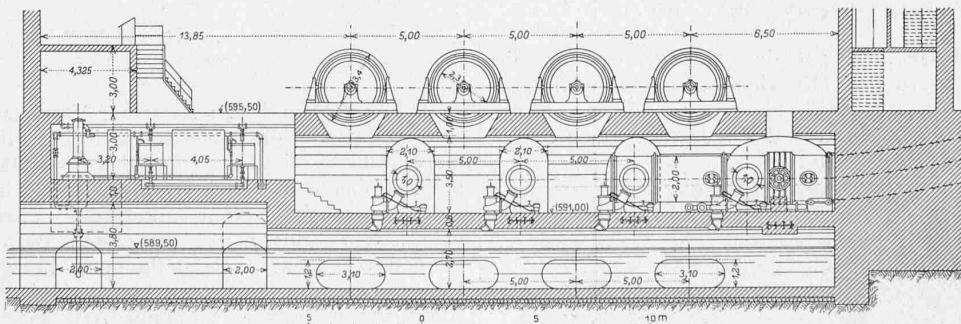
Längsschnitt C-D zu Abb. 31 des Maschinenhauses. — Masstab 1:300.
